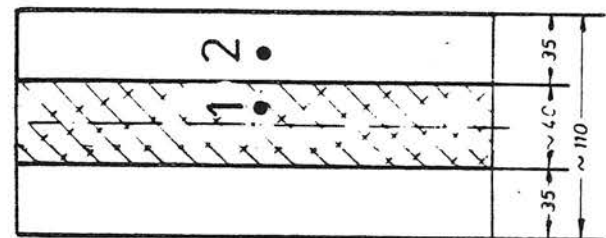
/46b: Isolierelemente zur Gebäudelagerung mit Federcharakteristik
